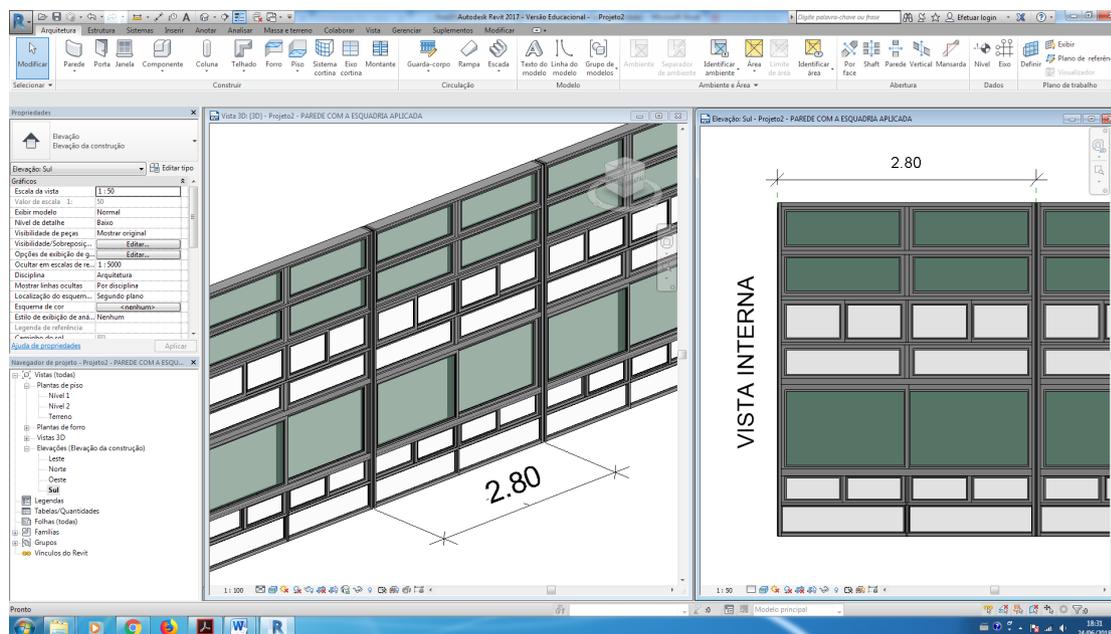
Modelagem componente principal, aplicado em parede-cortina. Fonte: AUTOR (2018).
